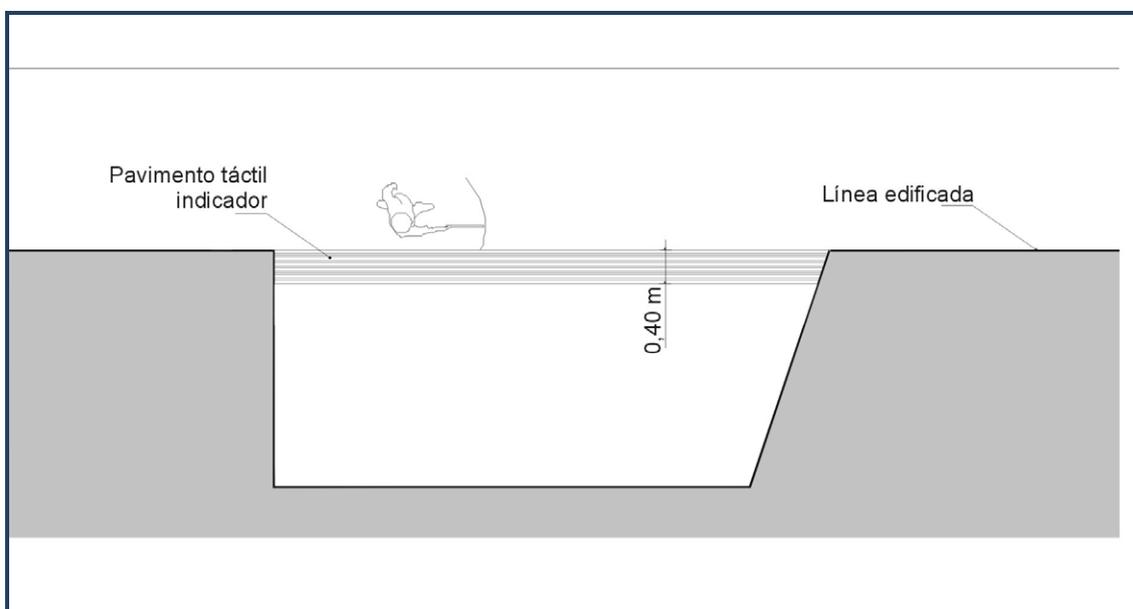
Franja de pavimento táctil indicador direccional que da continuidad a la línea edificada
